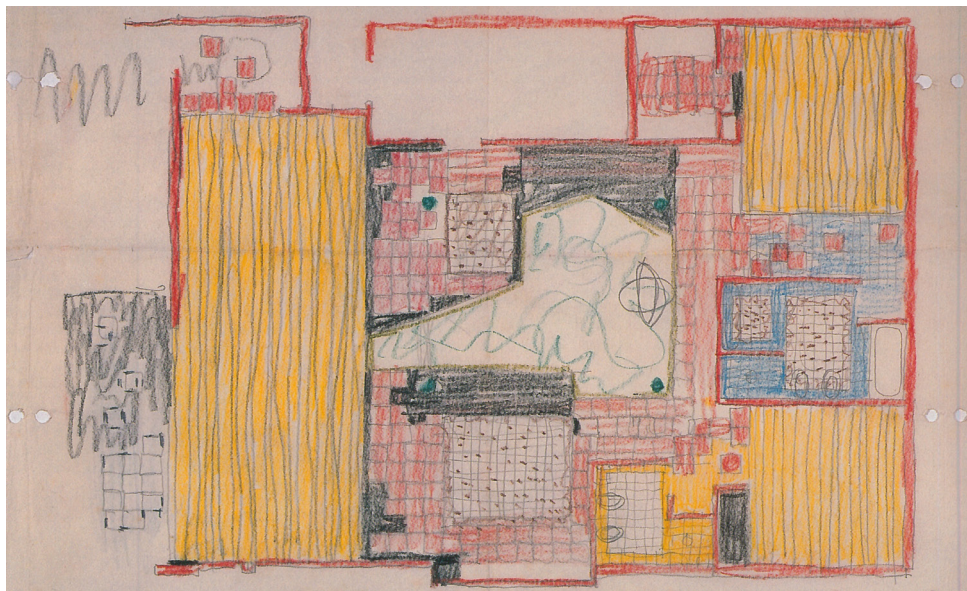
Estudo de Vilanova Artigas para o pavimento.
